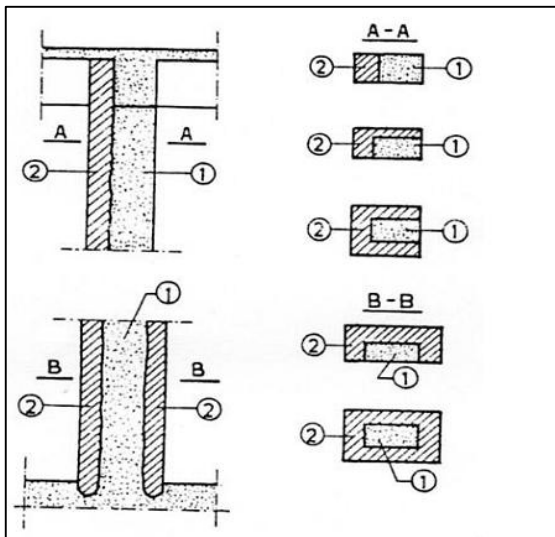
Différents arrangements de chemisage des poutres en BA .1-le poteau existant et 2-la façon de chemisage.
